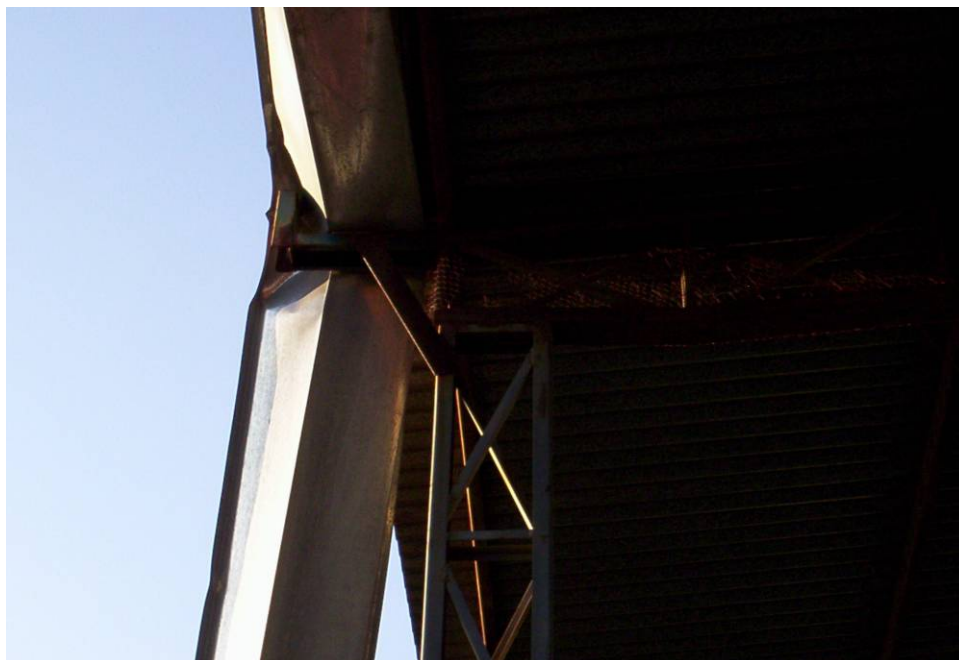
A calha da cobertura da arquibancada caiu. Ver também foto 01.
